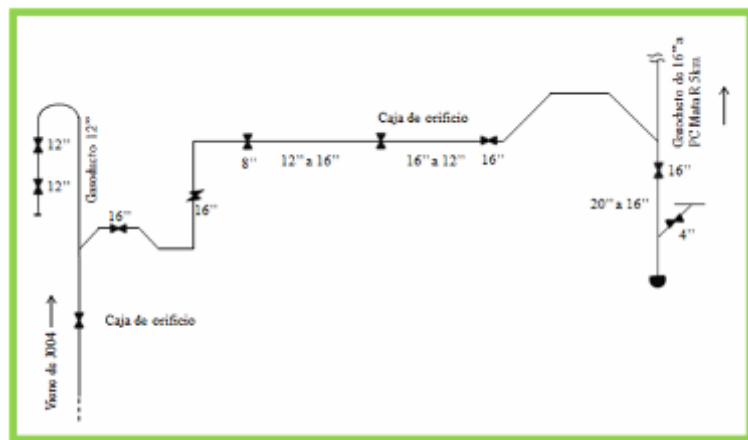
Esquemático de la Planta Compresora Zapatos
